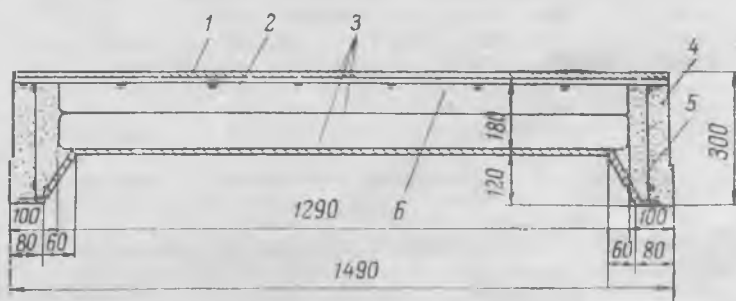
Поперечное сечение многослойной панели: 1 — асбестоцемент; 2 — фибролит; 3 — склеивающие прослойки; 4 — ребра; 5 — сварной каркас; 6 — арматурная сетка
